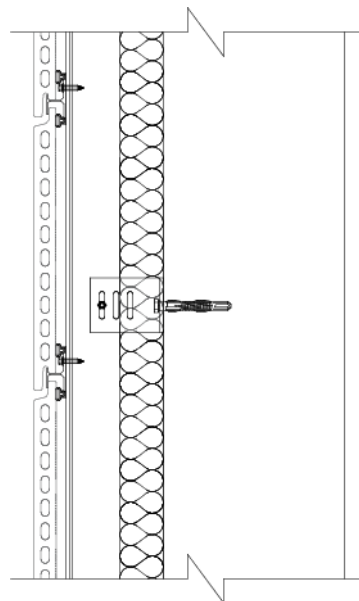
Kit Tempio® FK. Arranque de fachada.
